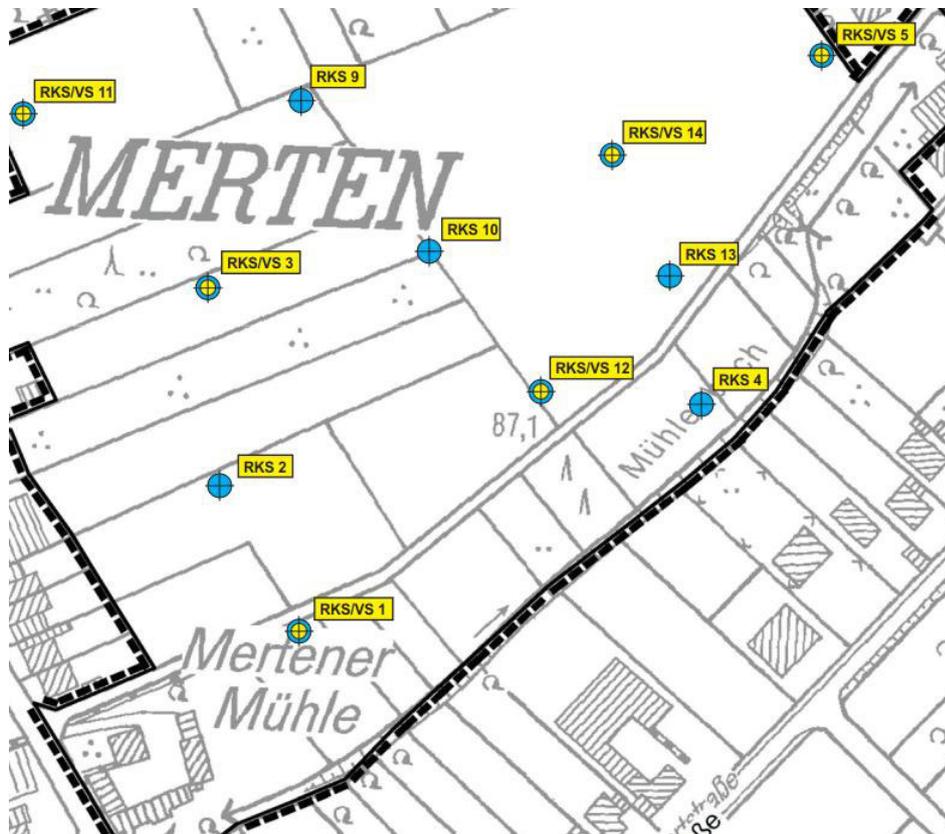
Ausschnitt aus dem Lageplan der Rammkernsondierungen [8]
